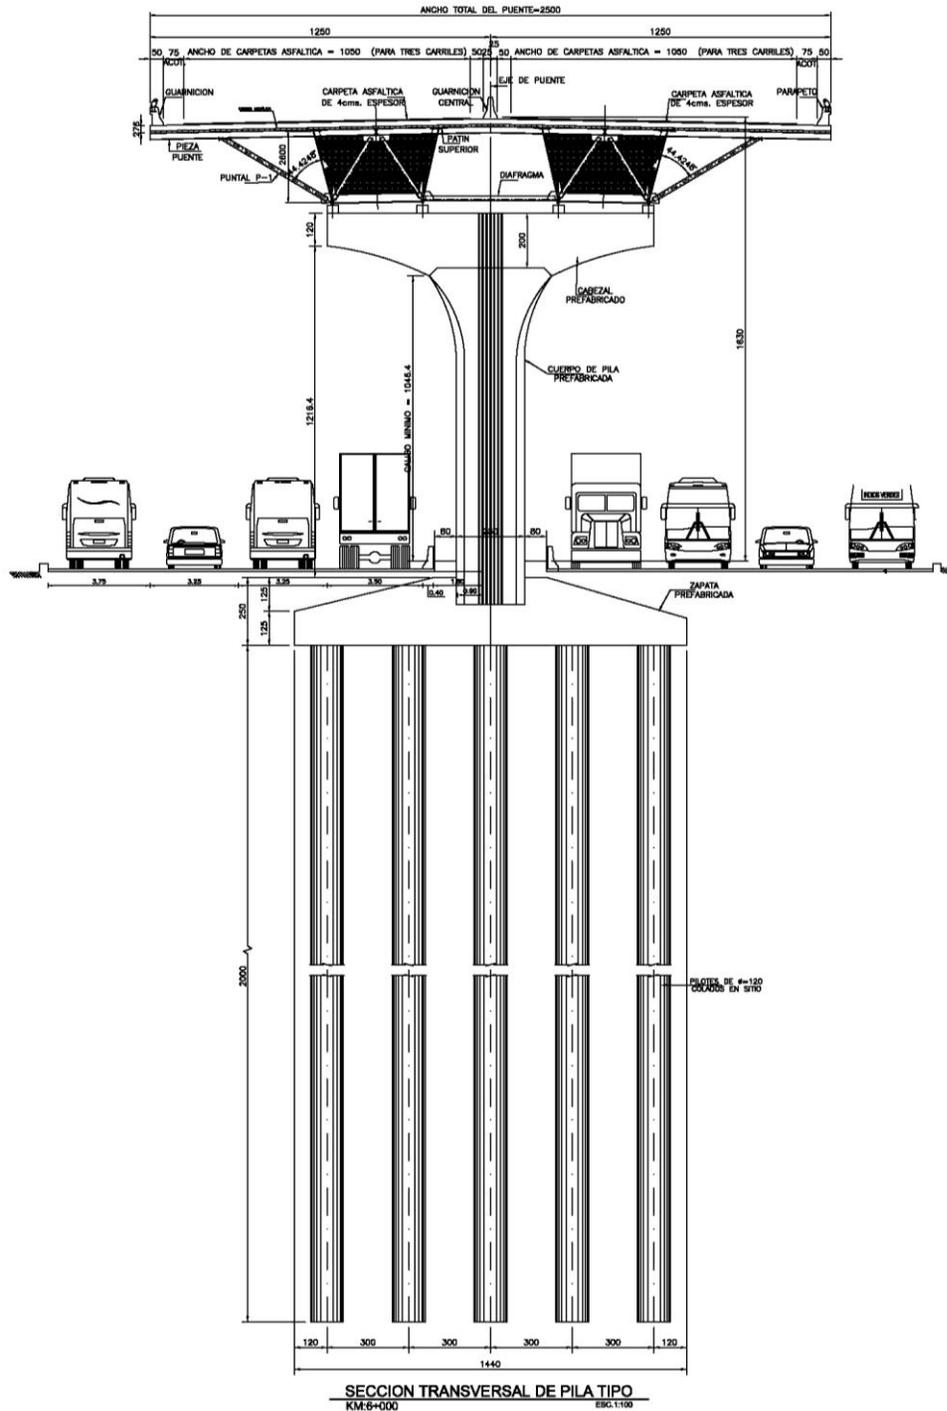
Sección transversal tipo para tramos de tres carriles por sentido A6 cimentados con pilas coladas en sitio.
